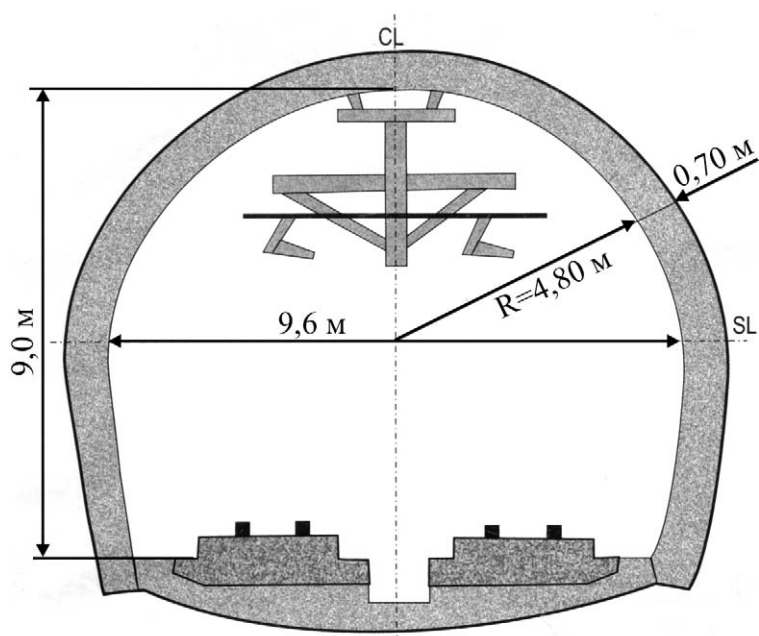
Поперечное сечение тоннеля Сэйкан
